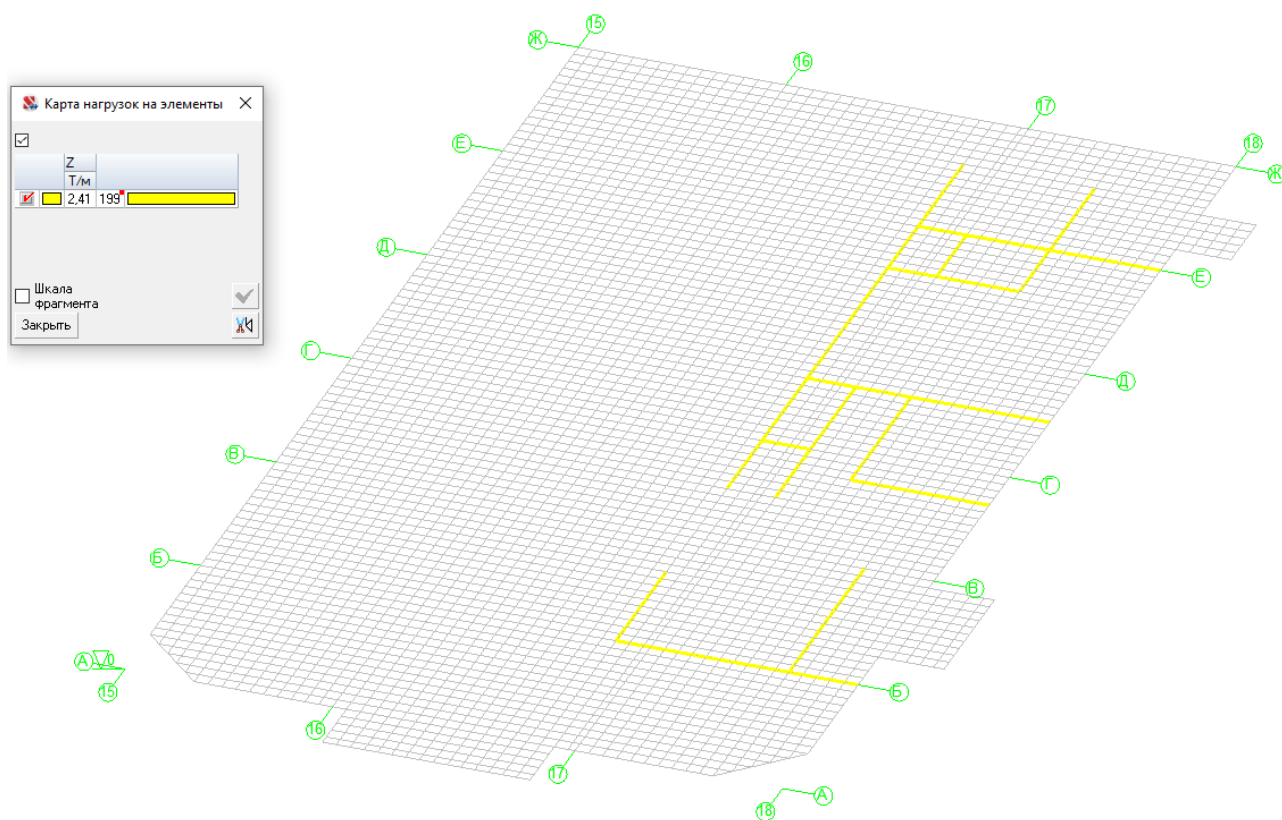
Нагрузка на плиту перекрытия от веса перегородок
